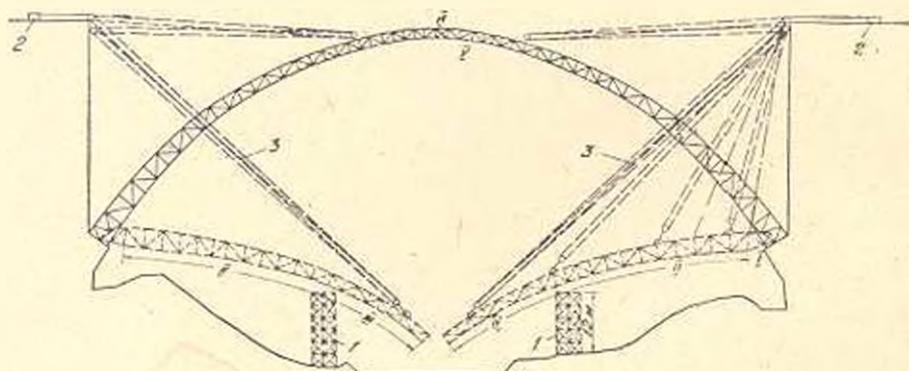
Схема монтажа стального каркаса арки. Римскими цифрами показана последовательность сборки полуарок. 1—временные деревянные опоры; 2—лебедки; 3—полиспасты
